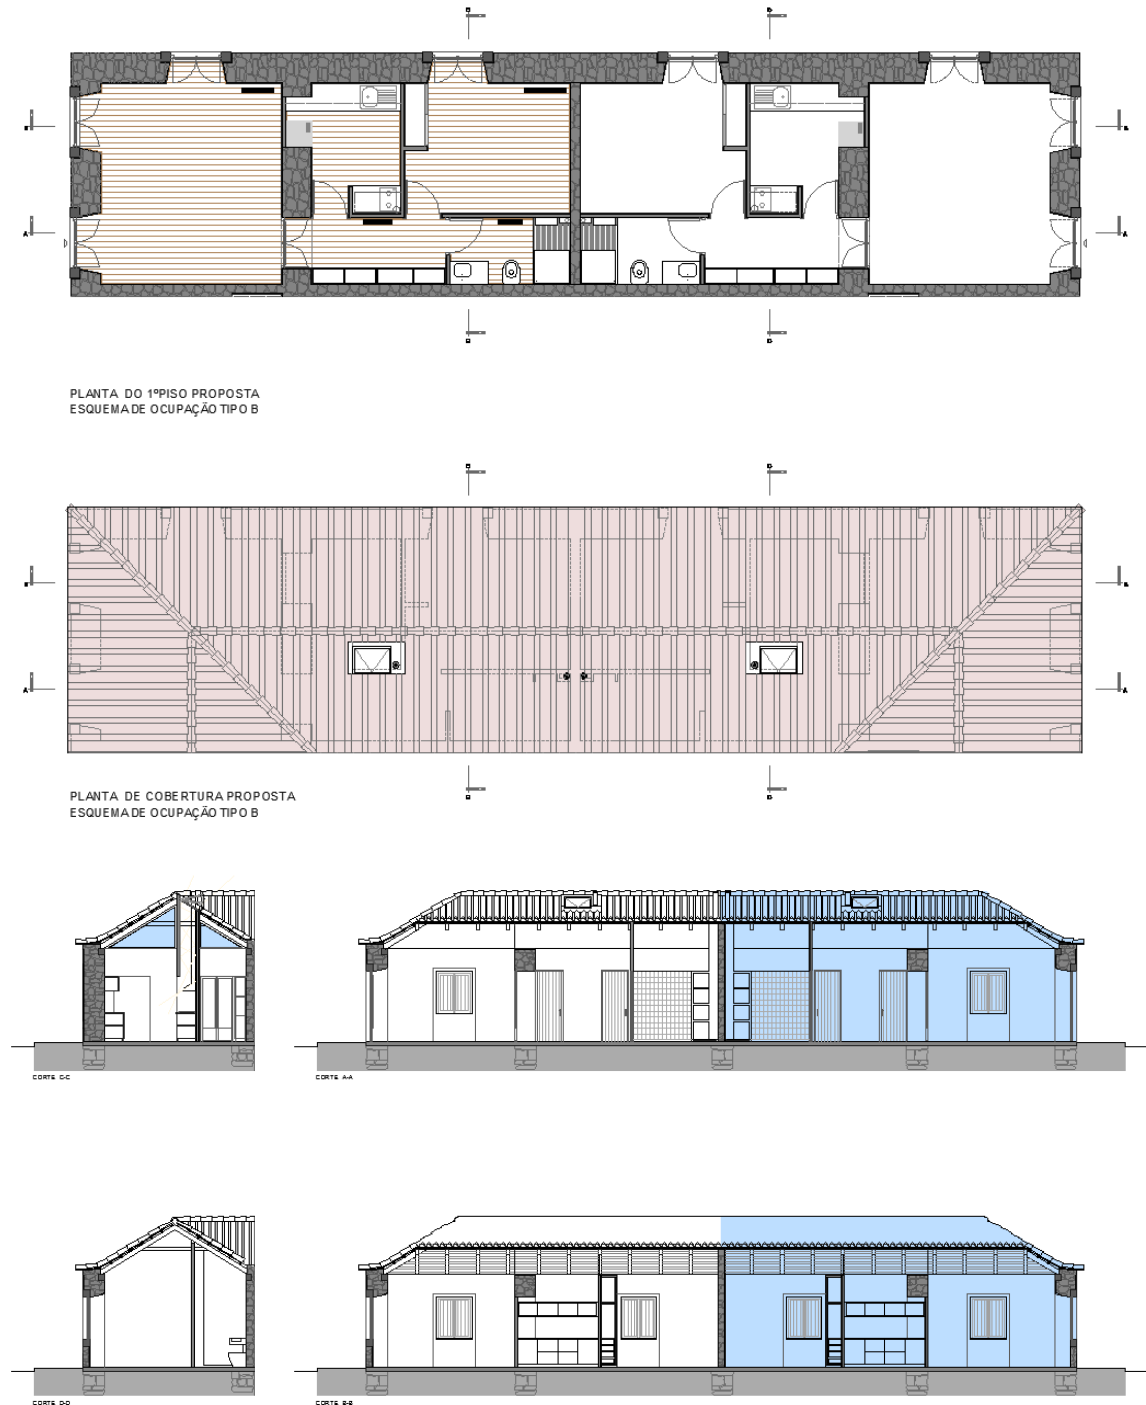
Plantas e cortes de um módulo duplo de topo – proposta (quarteirão Q11)
